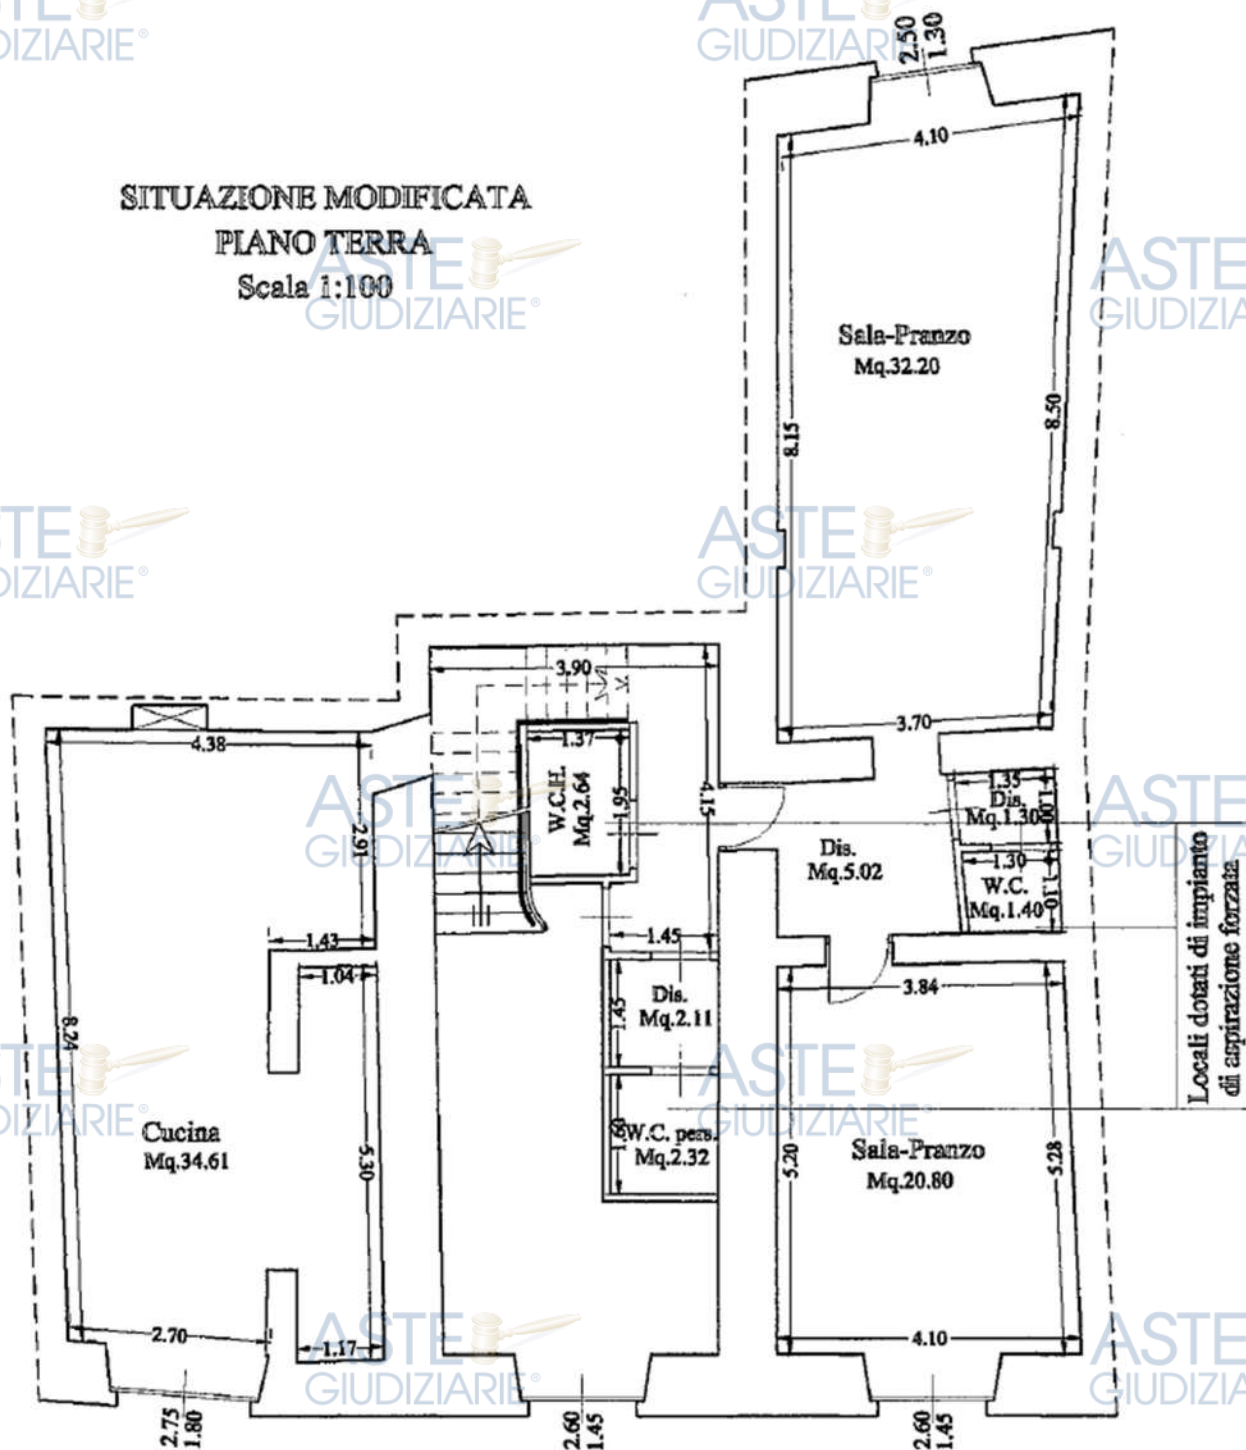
Ultimo progetto approvato (A.E. N. 105/2007)
